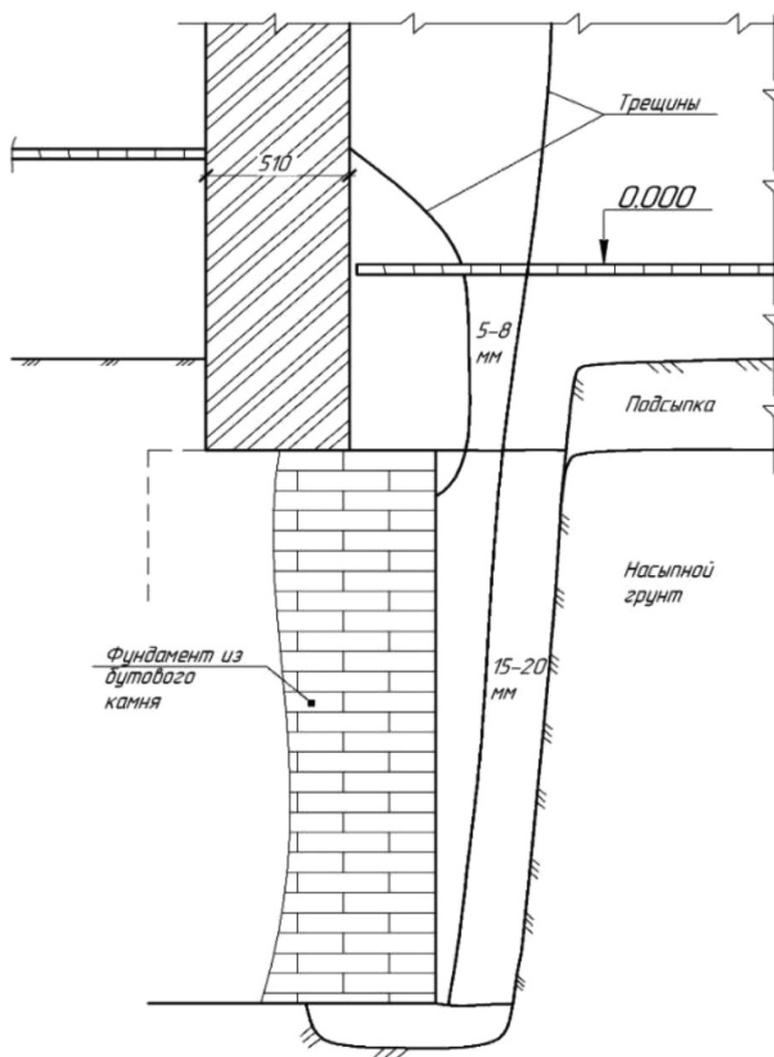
Схема развития трещин в фундаменте торцевой стены по оси 1
